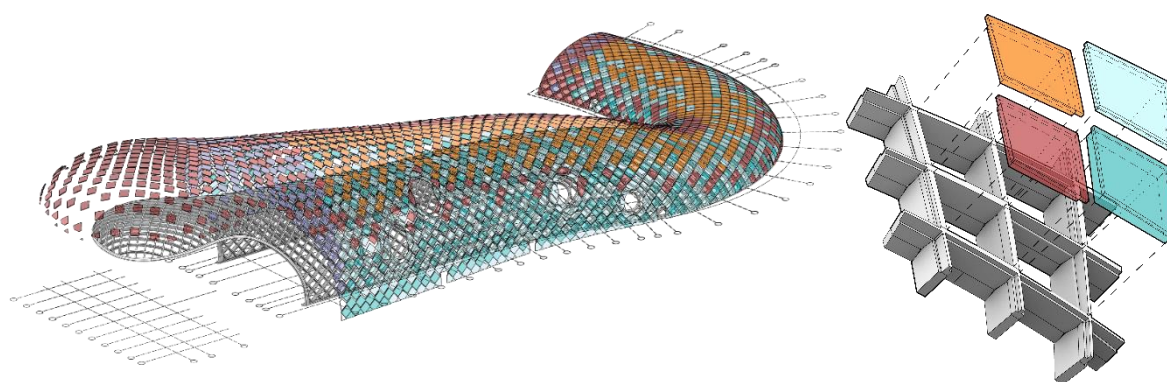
Ausschreibungs-Model: Hüllvolumen Holzbau und Fassade
